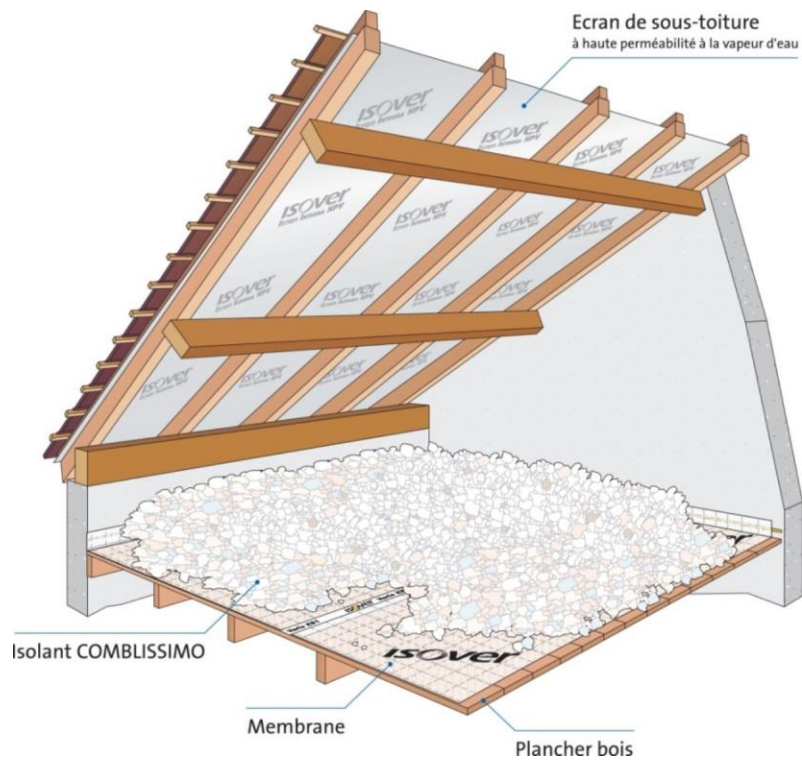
Pose sur plancher de comble perdu : mise en œuvre d'isolant en vrac sur plancher de comble perdu
